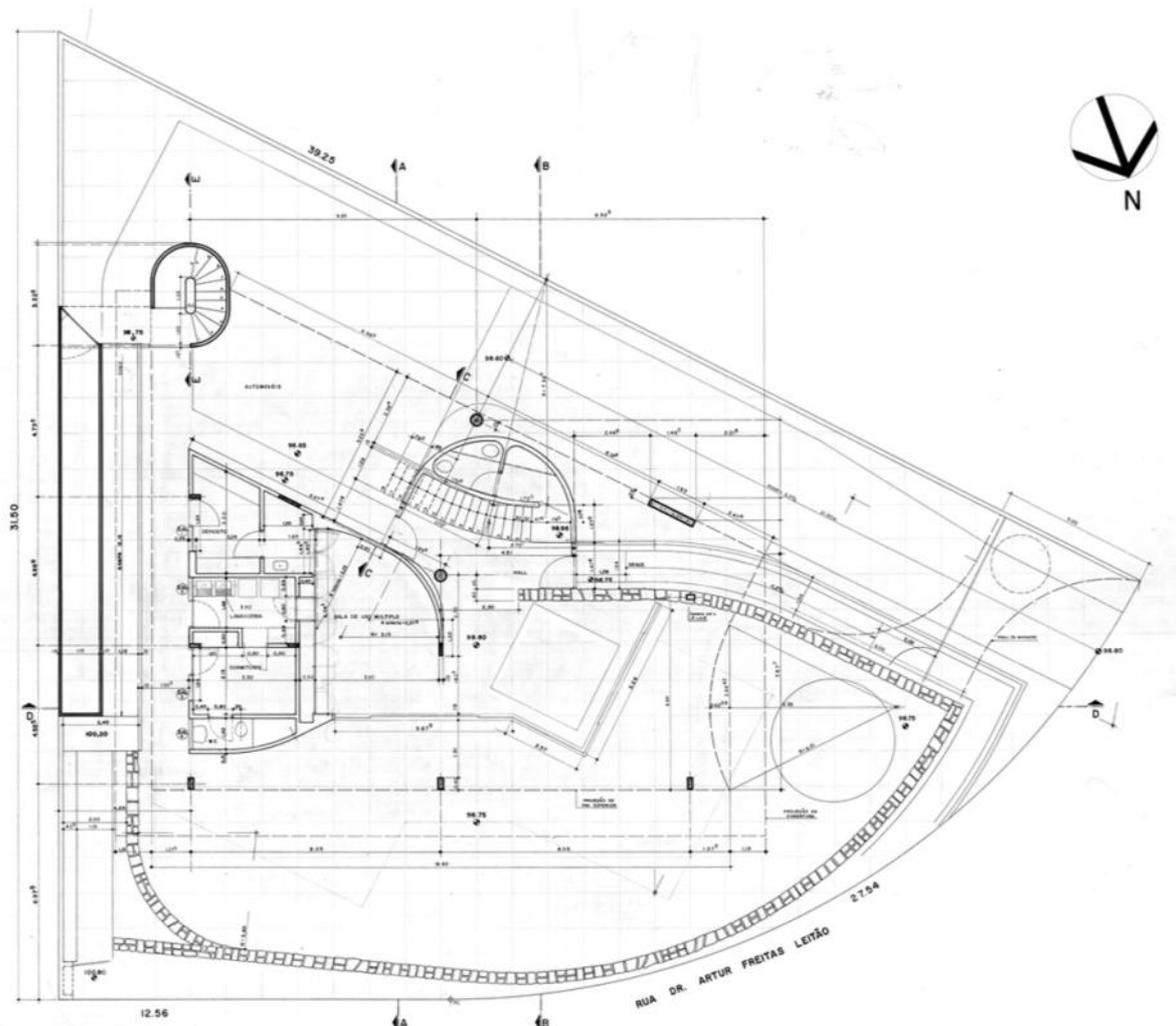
Residência L.N. Pascoal. Planta do pavimento térreo. Fonte: acervo Gilberto Pascoal
